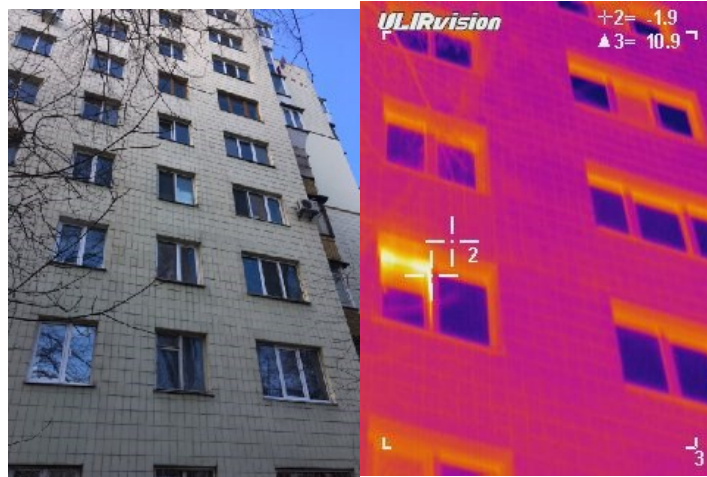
Тепловізійна зйомка фасаду будинку
